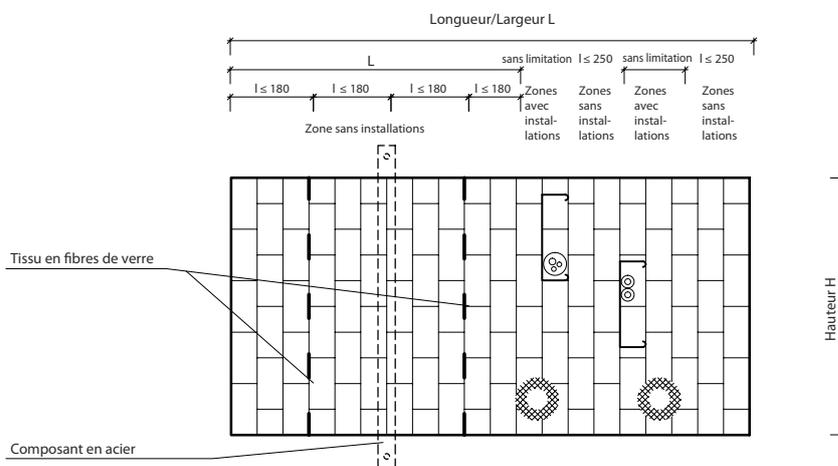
Support des zones de calfeutrement de 144 mm d'épaisseur dans les plafonds
